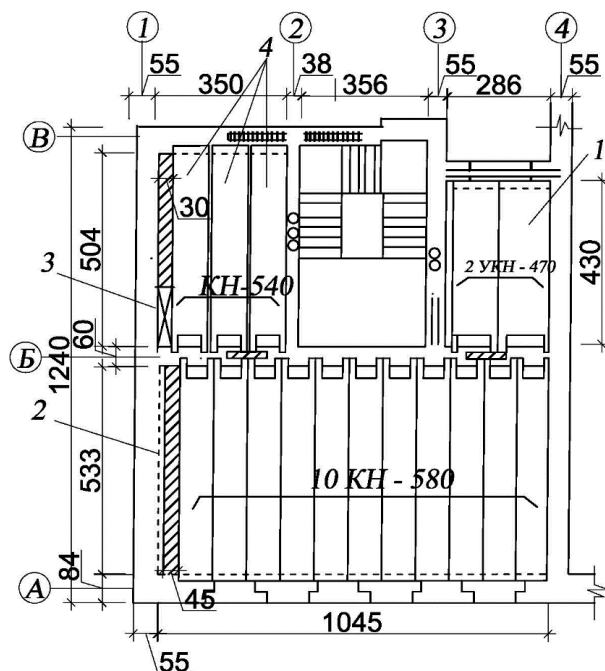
План участка перекрытия из железобетонных двухпустотных настилов с выпускными ребрами: 1 – укороченные трехпустотные настилы; 2 – железобетонная заделка; 3 – вентиляционный блок; 4 – первая захватка.
